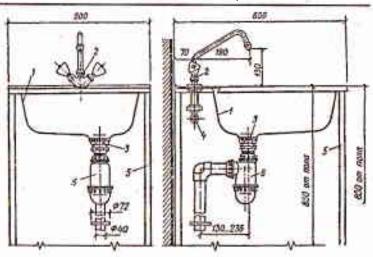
Монтажная схема установки мойки: 1—чаша; 2— смеситель; 3— выпуск; 4— подводка водопровода; 5— подстолье; 6— гидрозатвор
